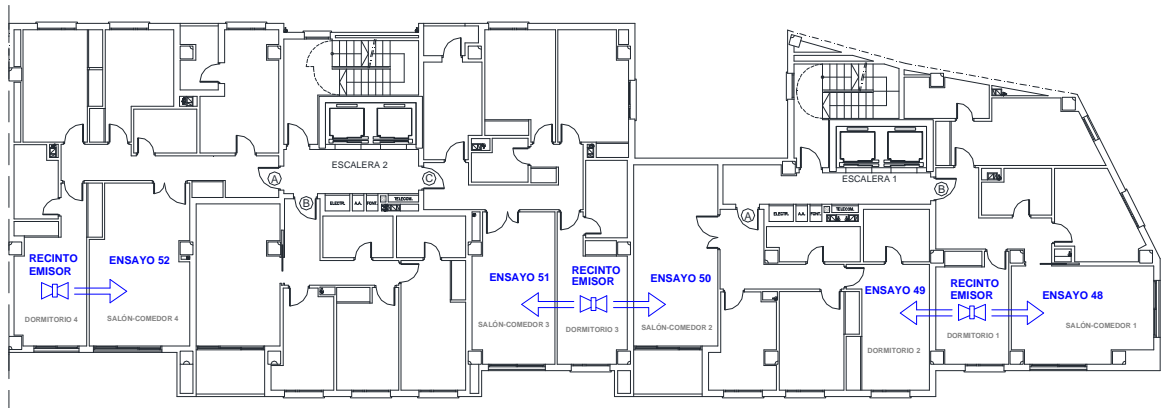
Plano de ubicación de los ensayos, planta tercera.
